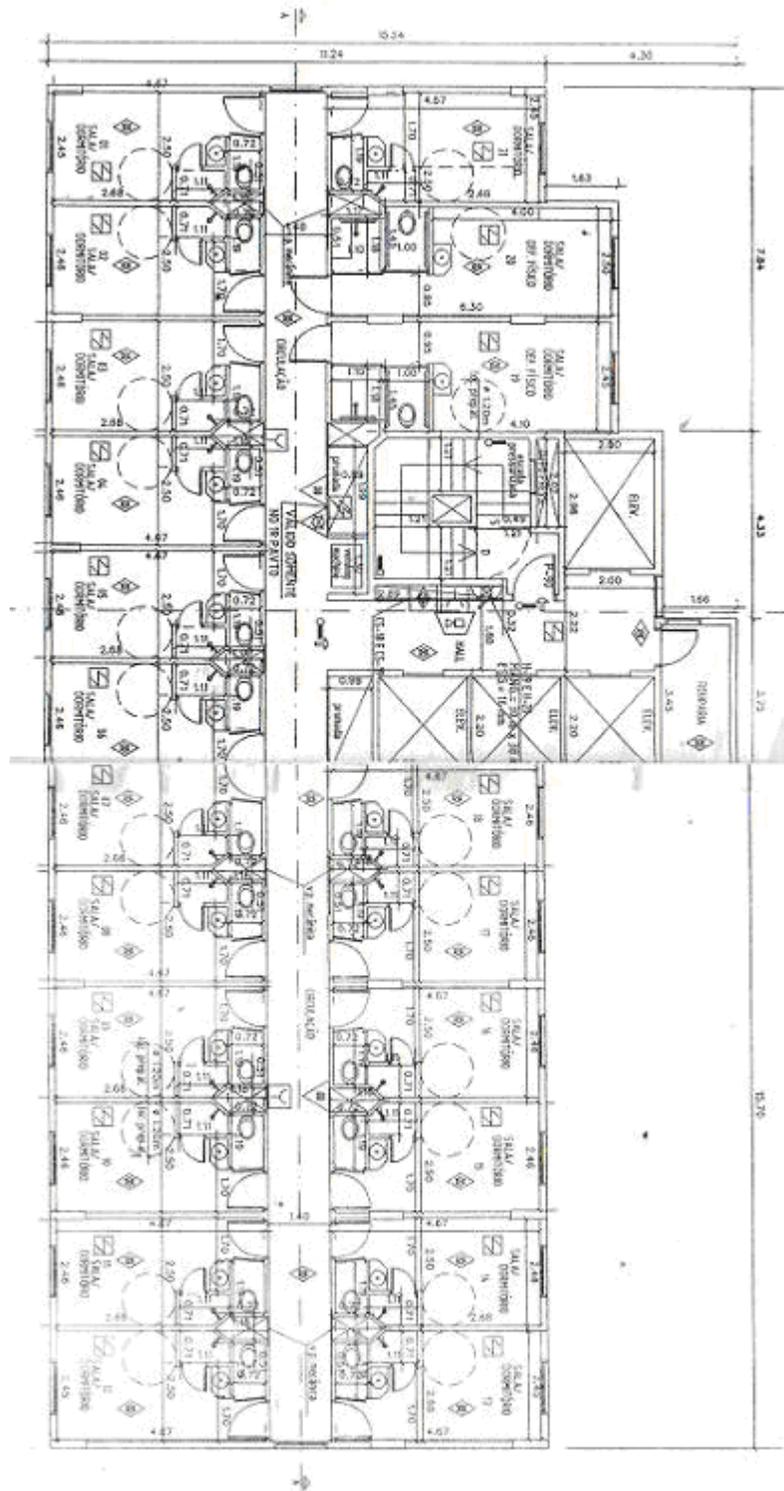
Planta do pavimento tipo da edificação analisada
